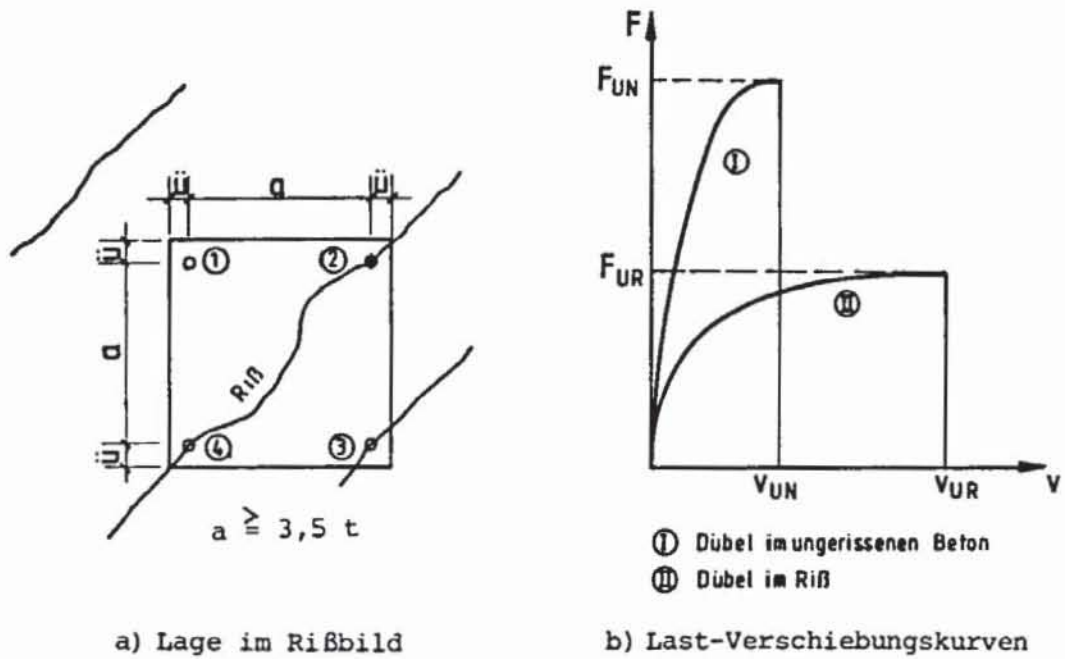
Ankergruppe in der gerissenen Zugzone eines Stahlbetonbauteils.
